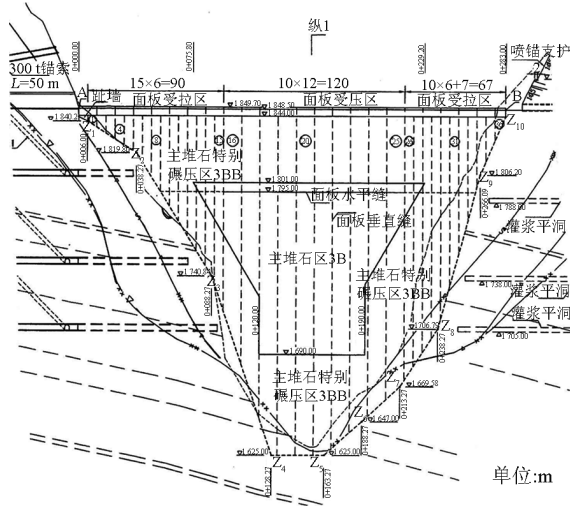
猴子岩混凝土面板堆石坝坝轴线剖面图
